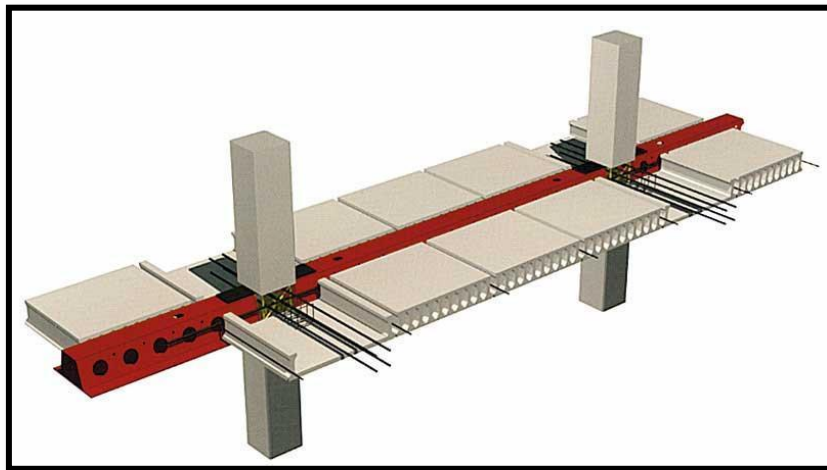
schéma présentatif d'un assemblage plancher-ossature
